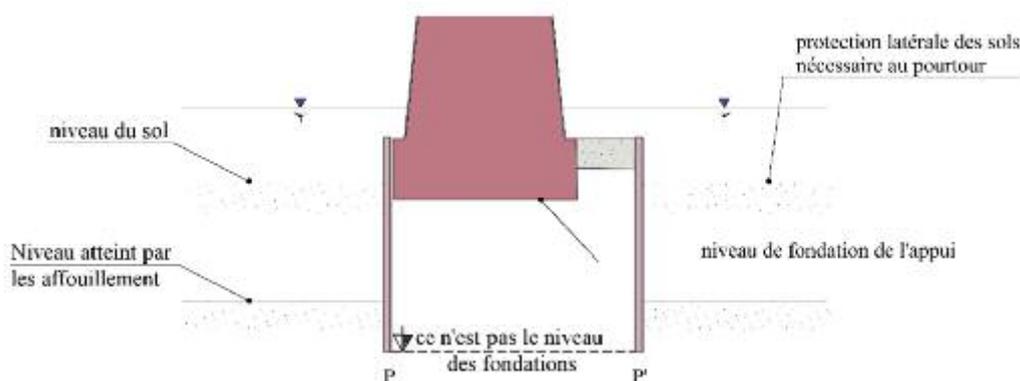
voile en béton au pourtour d'une fondation et érosion en sous-face
